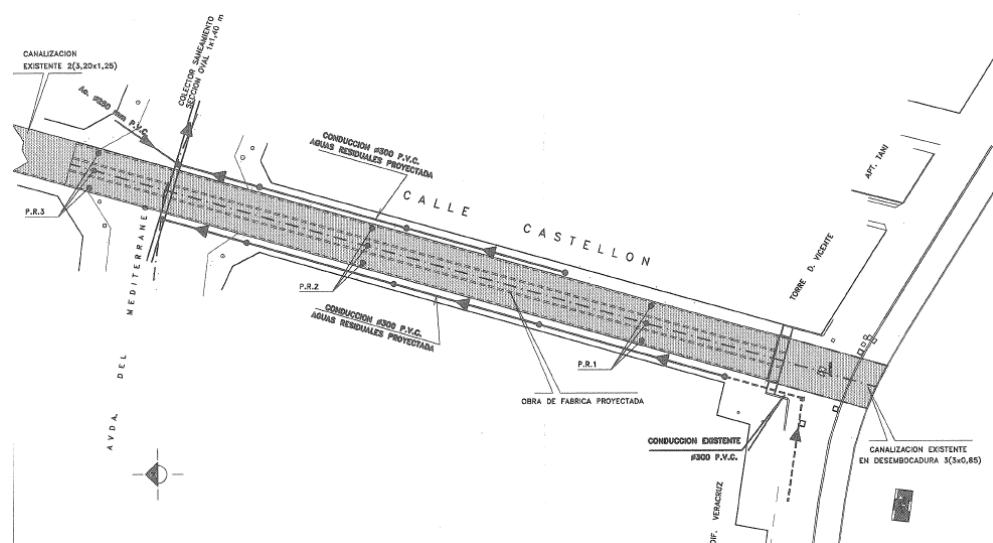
Extracto de la planta de Obras de Fábrica y red de residuales del proyecto de Canalización Barranco Barceló Fase 3 en Benidorm
